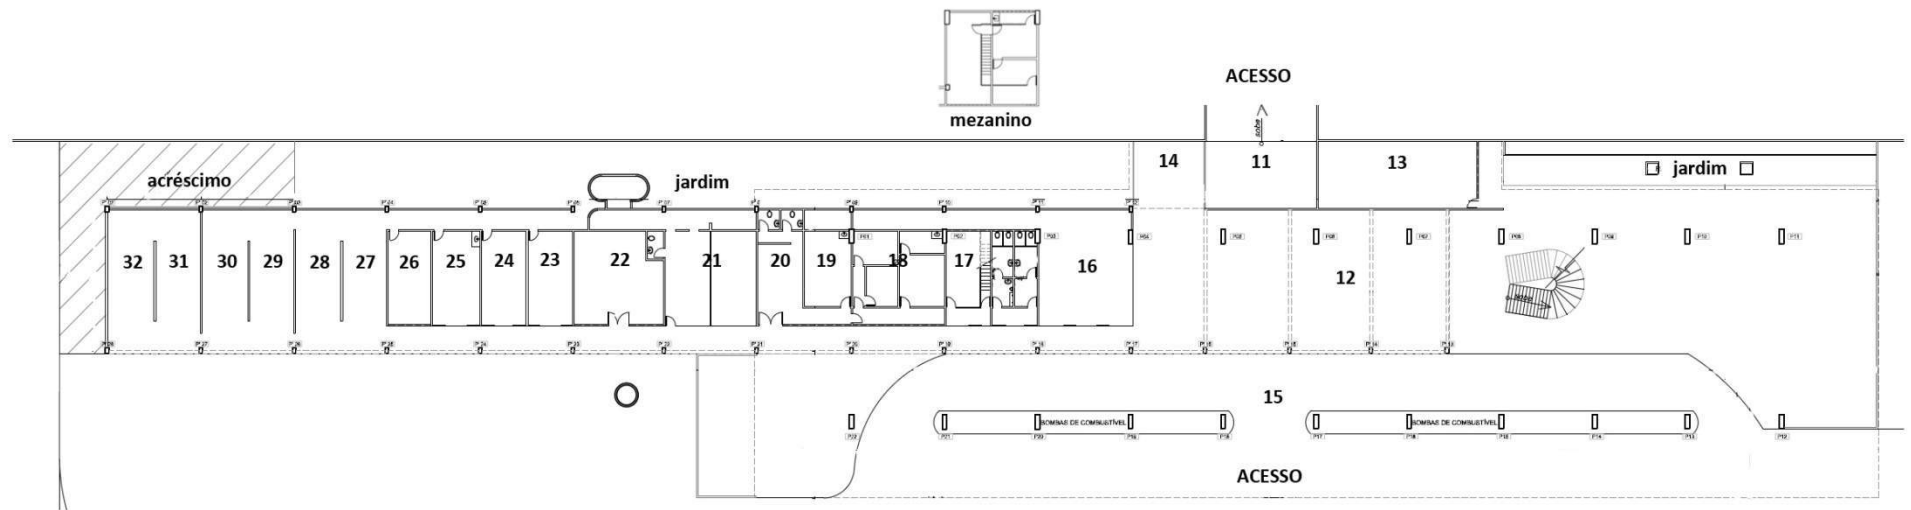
Planta do Piso inferior. Fonte: ALBERNAZ, 2012.
